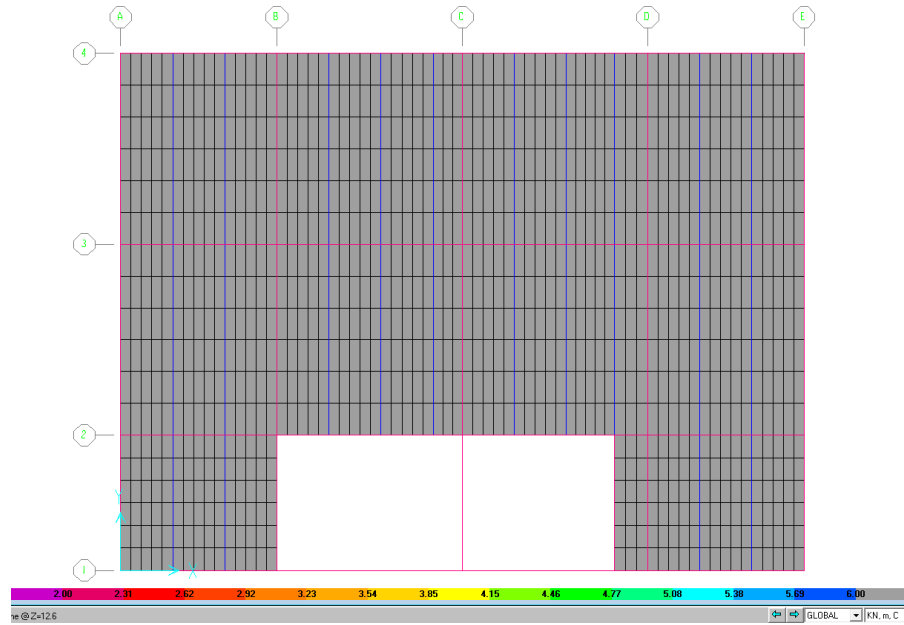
Planta nivel Mezzanine módulo de acceso estación 19 costado nor oriental aplicación de la carga viva (6,0 kN/m<sup>2</sup>)
